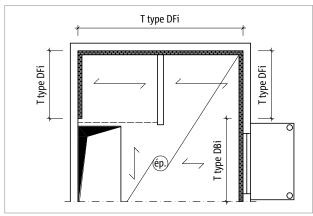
Schöck Rutherma® T type DF : plancher constitué de prédalles et façade en béton armé
